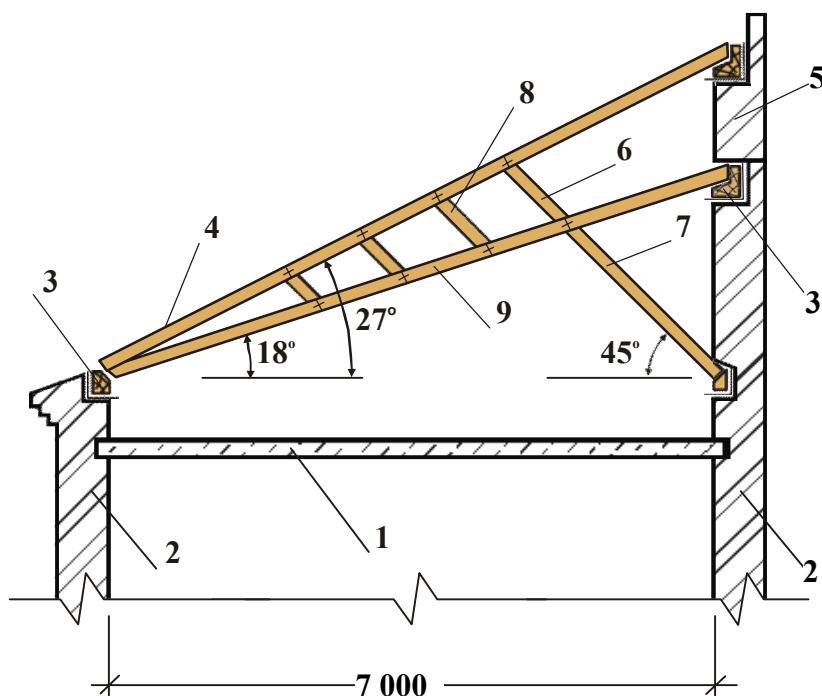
Збільшення нахилу схилів при прольотах до 7 м: 1 – горищне перекриття; 2 – стіни; 3 – маурерлат; 4 – знову встановлювана кроквяна нога; 5 – надбудована ділянка стіни; 6 – нарощувана ділянка підкоса; 7 – підкіс; 8 – накладки; 9 – наявна кроквяна нога
